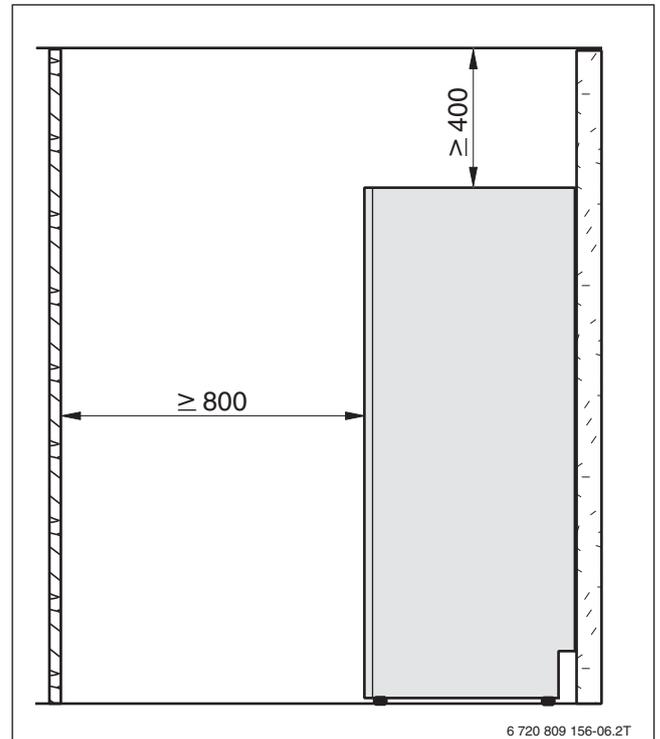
Mindestabstände des Towers, Seitenansicht (Maße in mm)
